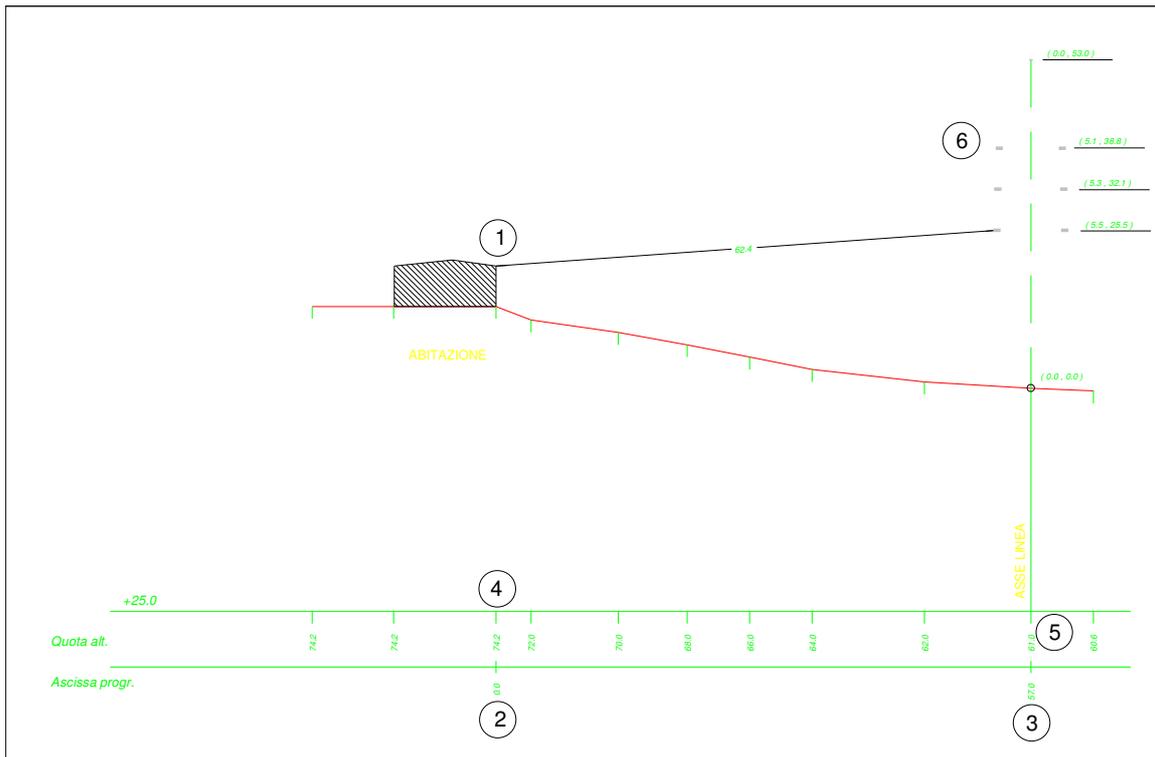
Vista della sezione trasversale dell'esempio di situazione espositiva riportato in Fig. 5.
